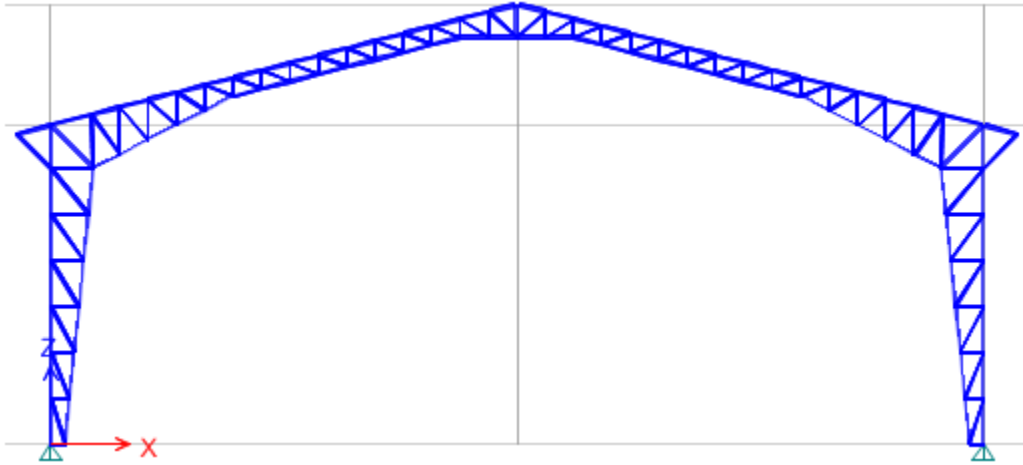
Modelado del Pórtico de la Estructura (ETABS)
